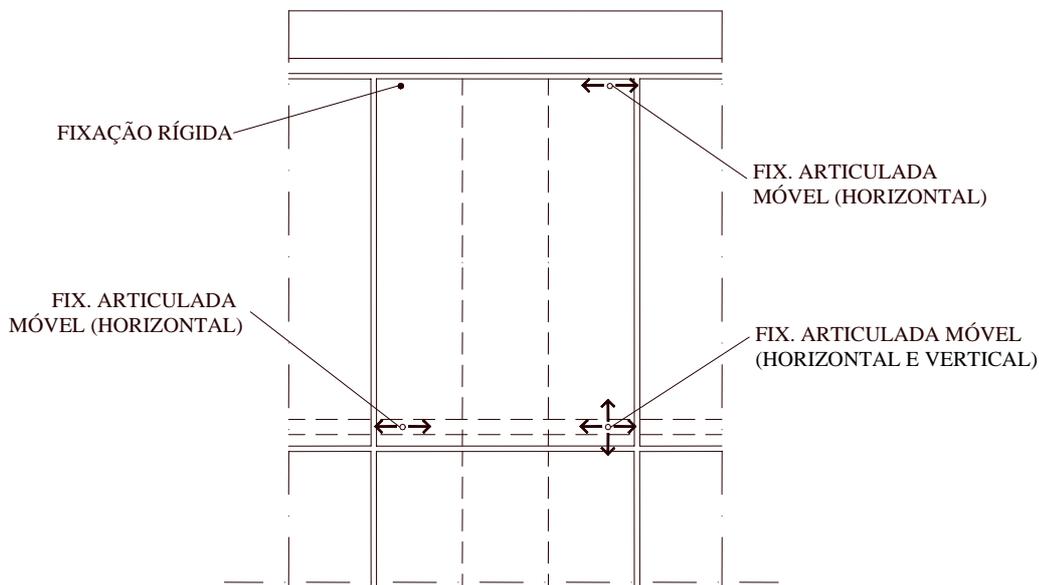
Elevação típica para um painel metálico com montante fixado na laje.
